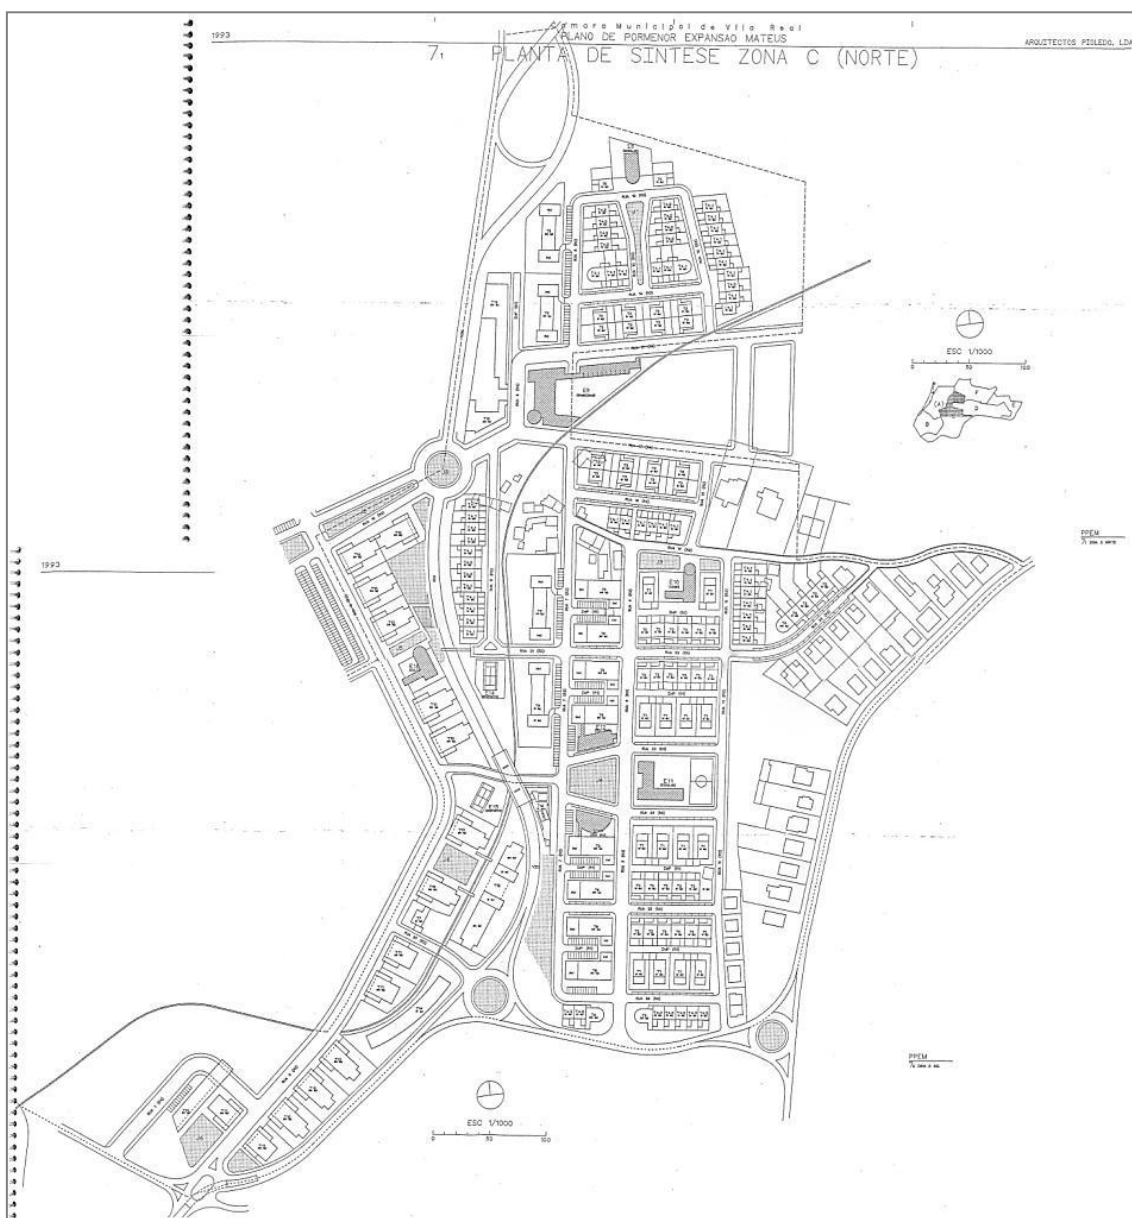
Planta de Síntese Zona C (norte e sul) da Proposta de Plano do PPEM (1993)
